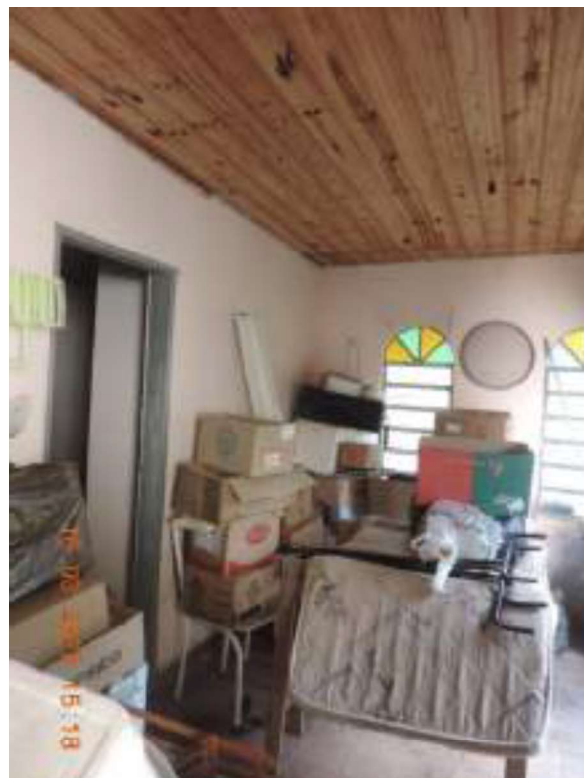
VISTA INTERNA DA EDIFICAÇÃO PRINCIPAL
